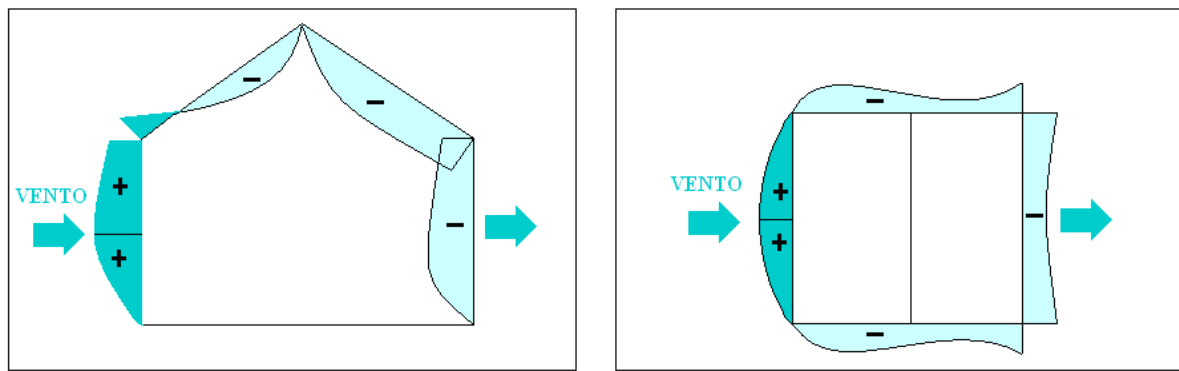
Distribuição de pressões nas fachadas de um edifício de planta rectangular (vista em corte vertical e vista em planta)
